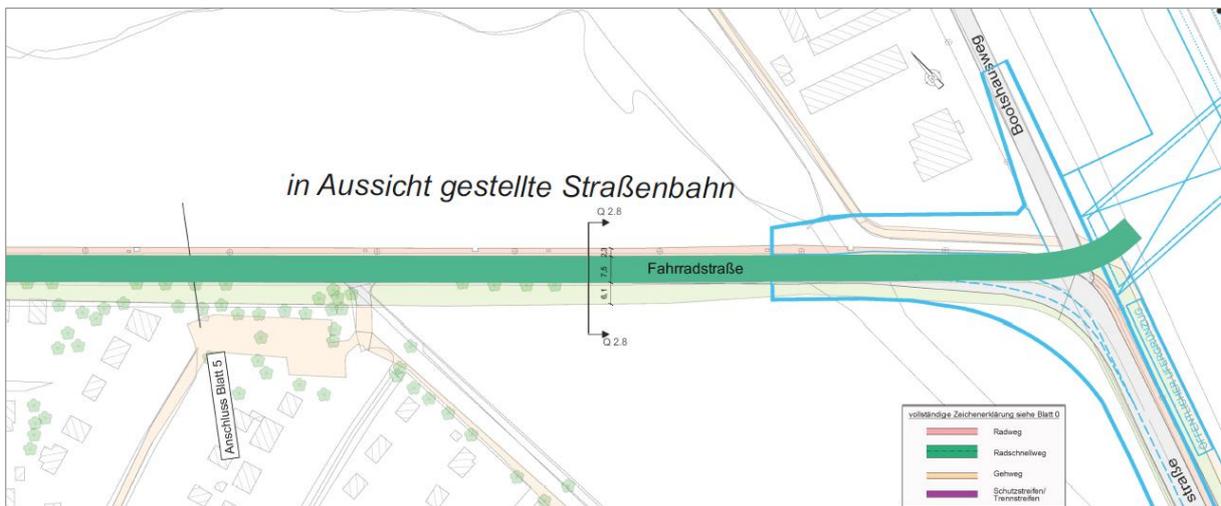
Rhenaniastraße mit Fahrradstraße (Variante 1)
